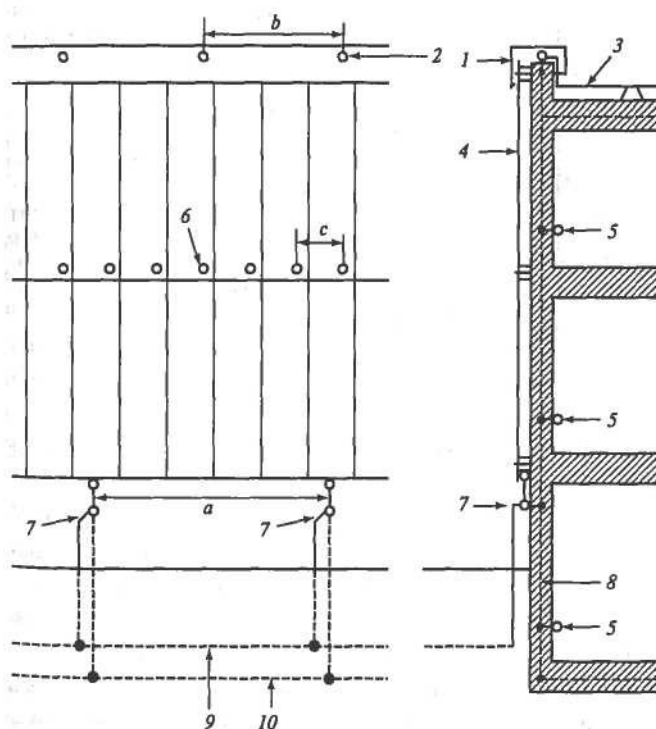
Использование металлического покрытия фасада в качестве естественной системы отвода тока молнии в железобетонном сооружении:
